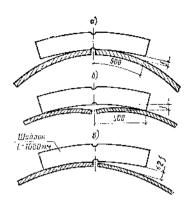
Схема проверки геометрической формы шаровой оболочки шаблоном (a-s)
